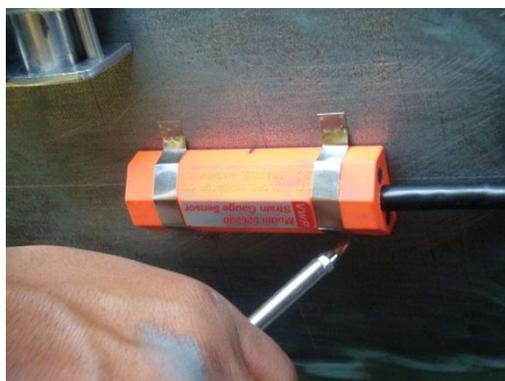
Esquema de colocación de puntos de soldadura
